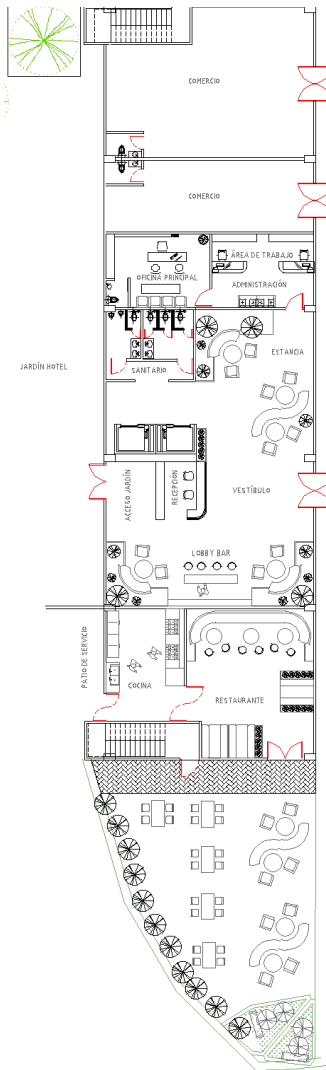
Croquis conceptual Planta Baja Hotel. Elaboración propia. 2022
